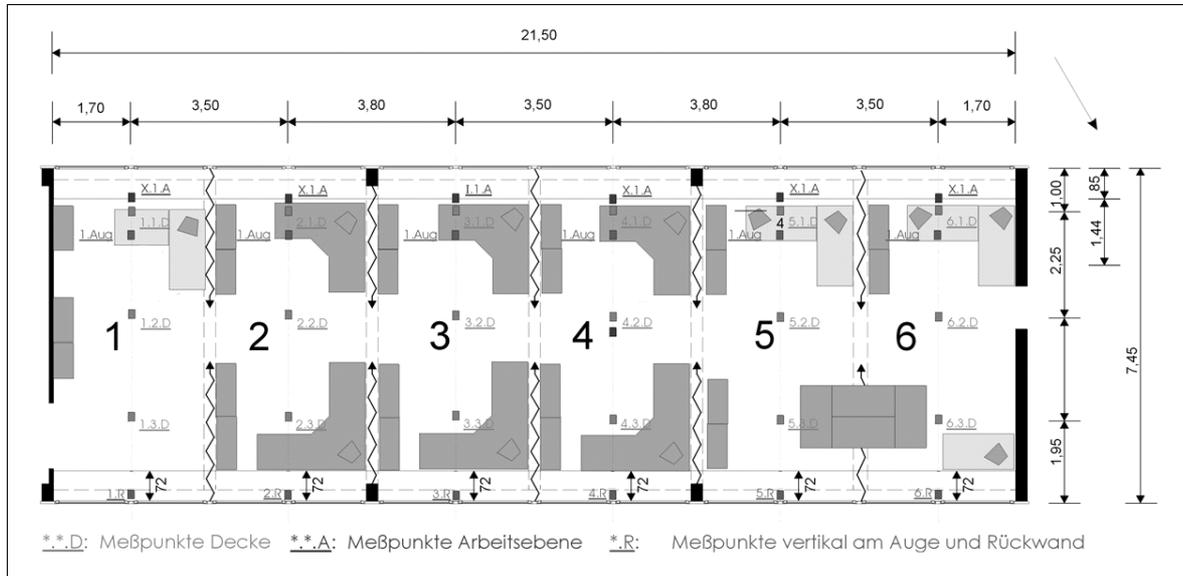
Anordnung der Beleuchtungsstärkemesspunkte im Grundriss
